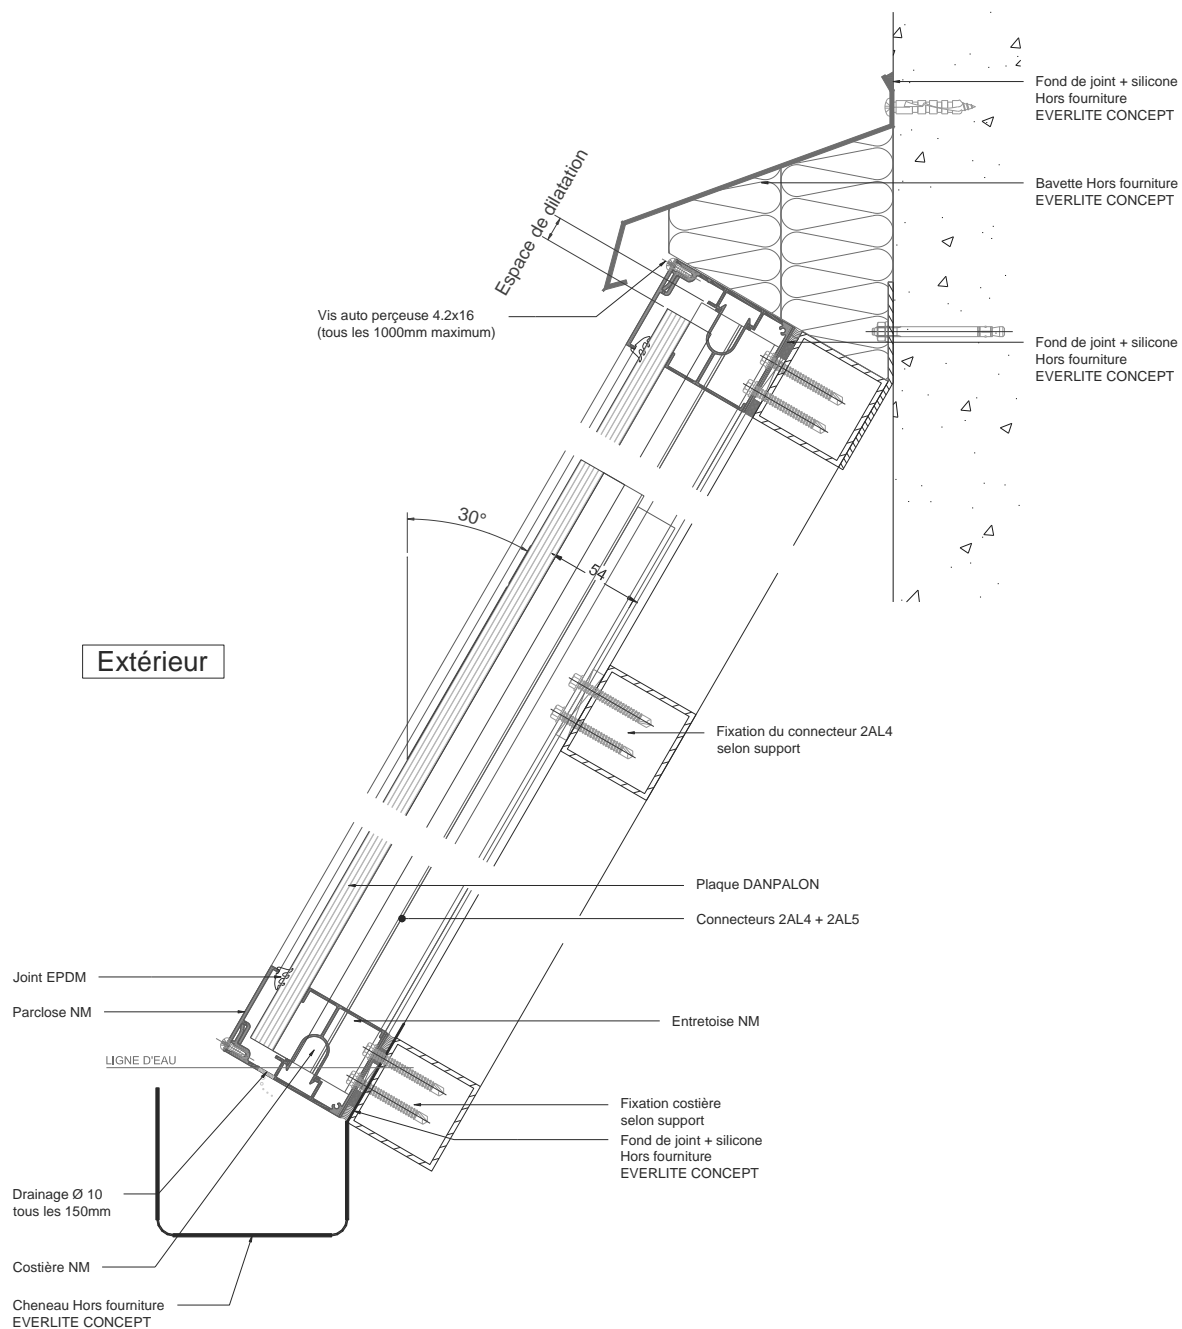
Coupe verticale sur connecteur aluminium 2AL4/2AL5 – système DANPALON® sur SHED
